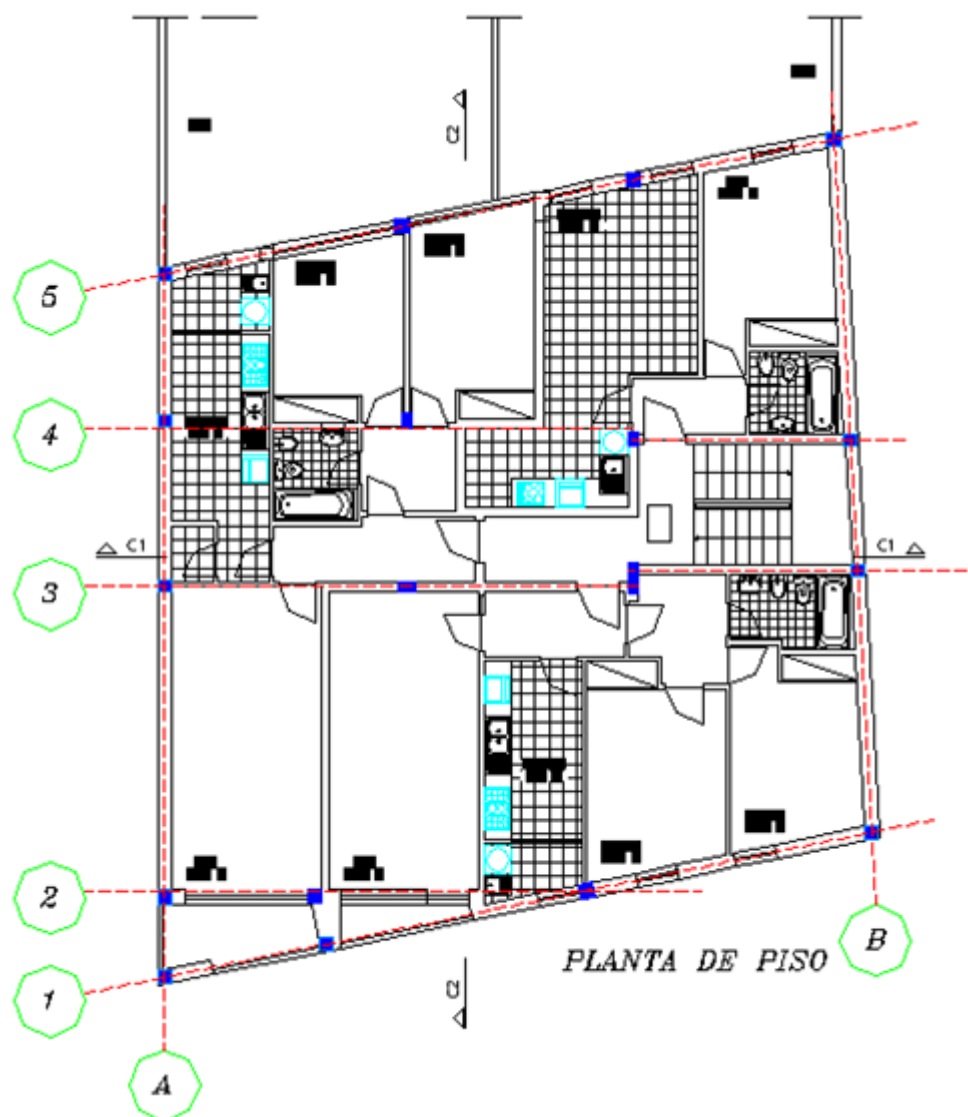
Solução estrutura adotada na planta dos pisos (sem escala)
